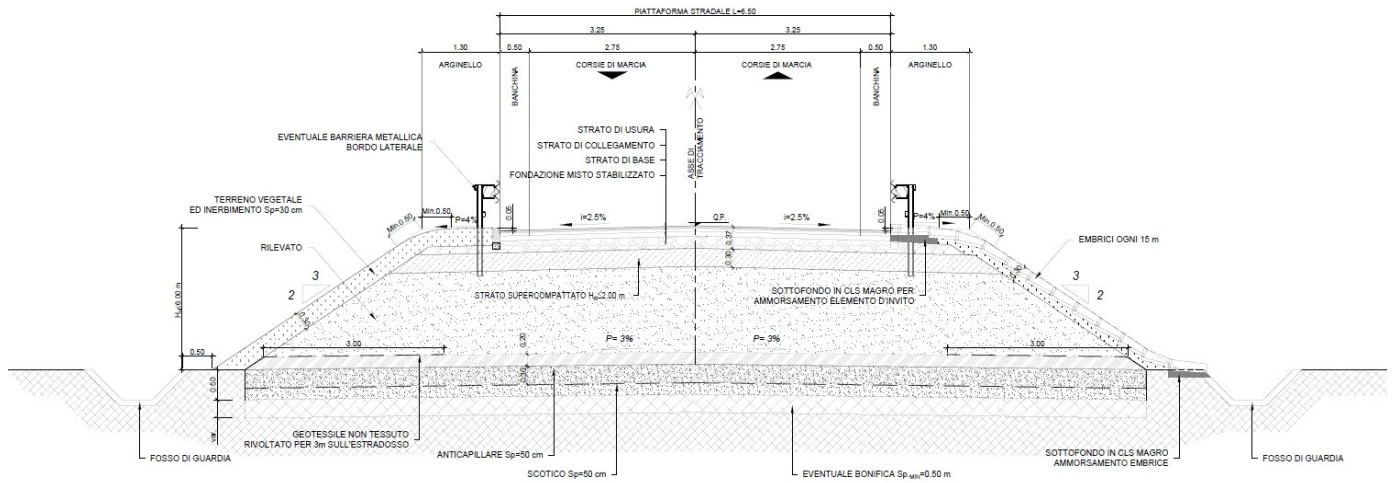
Dest. Particolare 6.5m - sezione tipo in rilevato $H_{ril} \leq 6.00$ m
